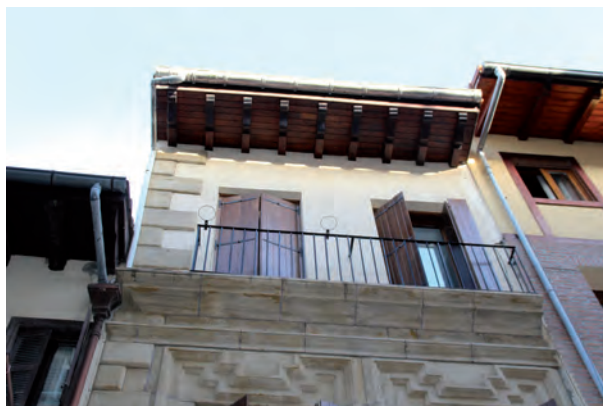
25. FACHADA DE SEGUNDA PLANTA
